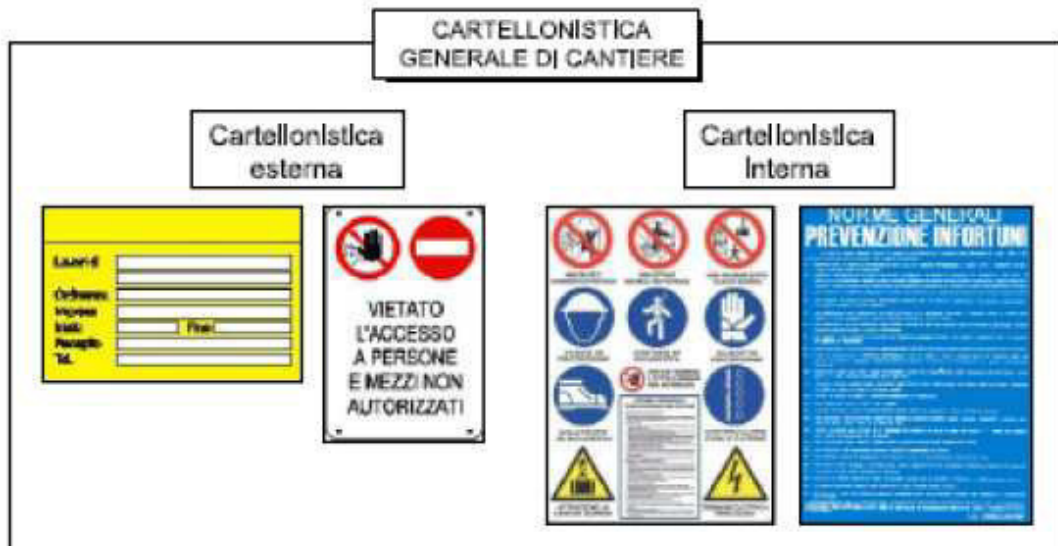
esempio di indicazione di segnaletica generale di cantiere
